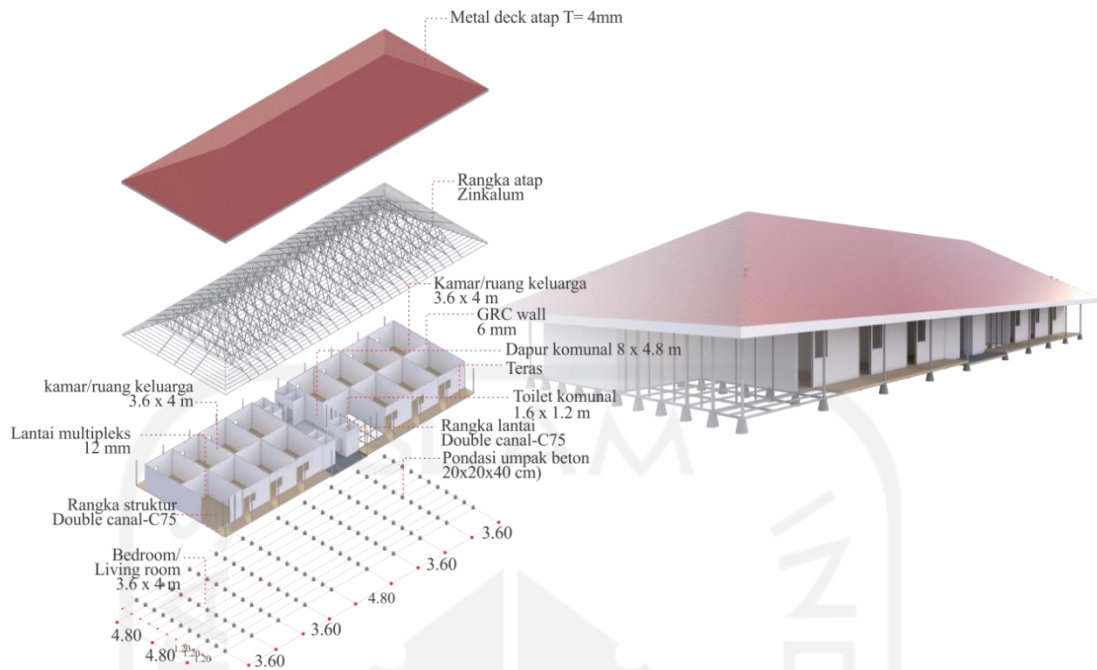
Potongan 2 denah Hunlara Kementerian PUPR
